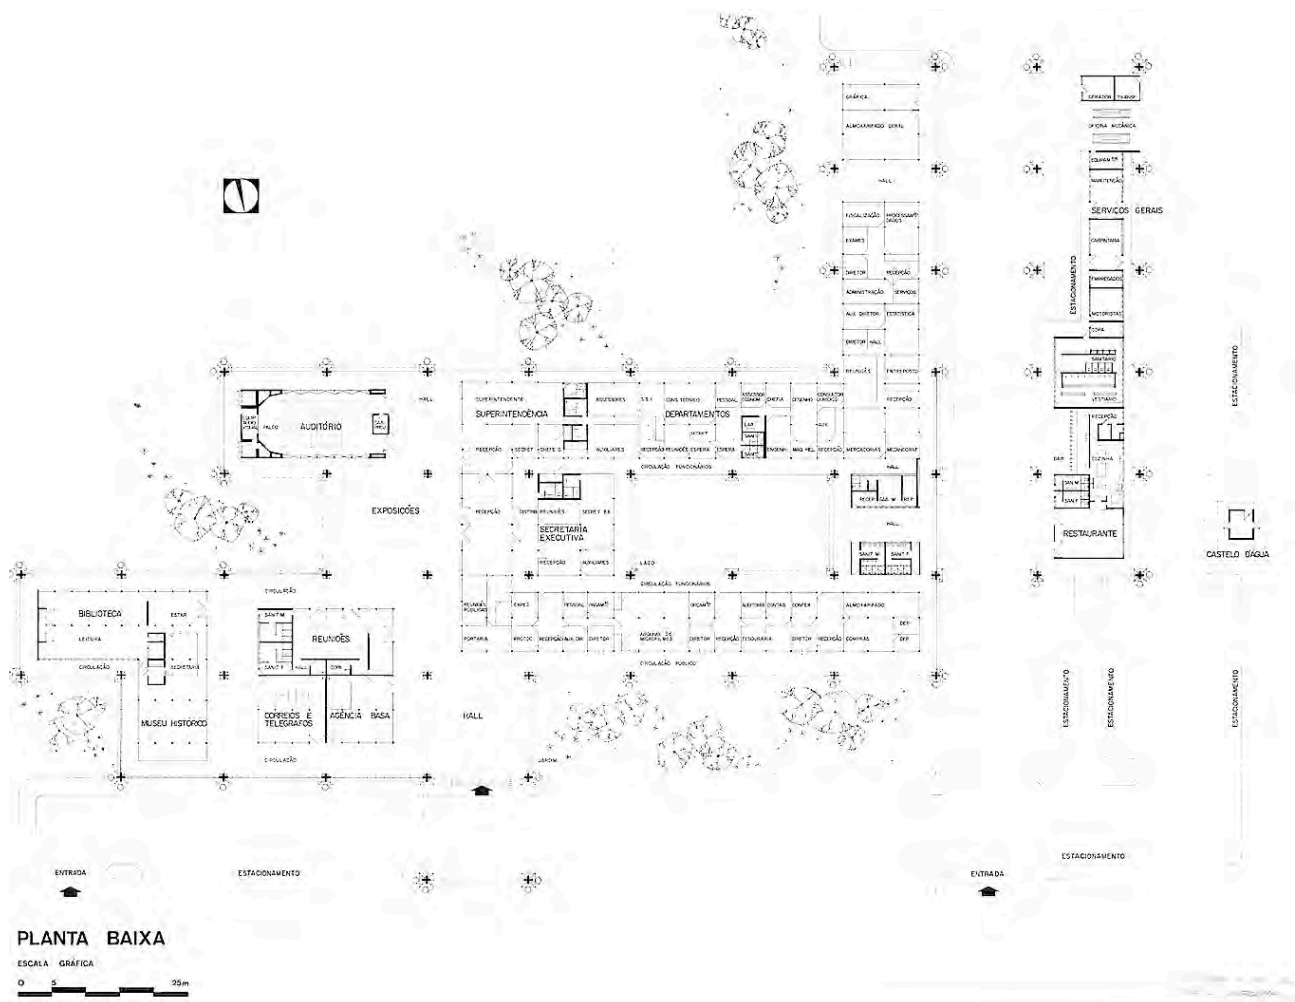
Sede da SUFRAMA. Planta, 1974.
